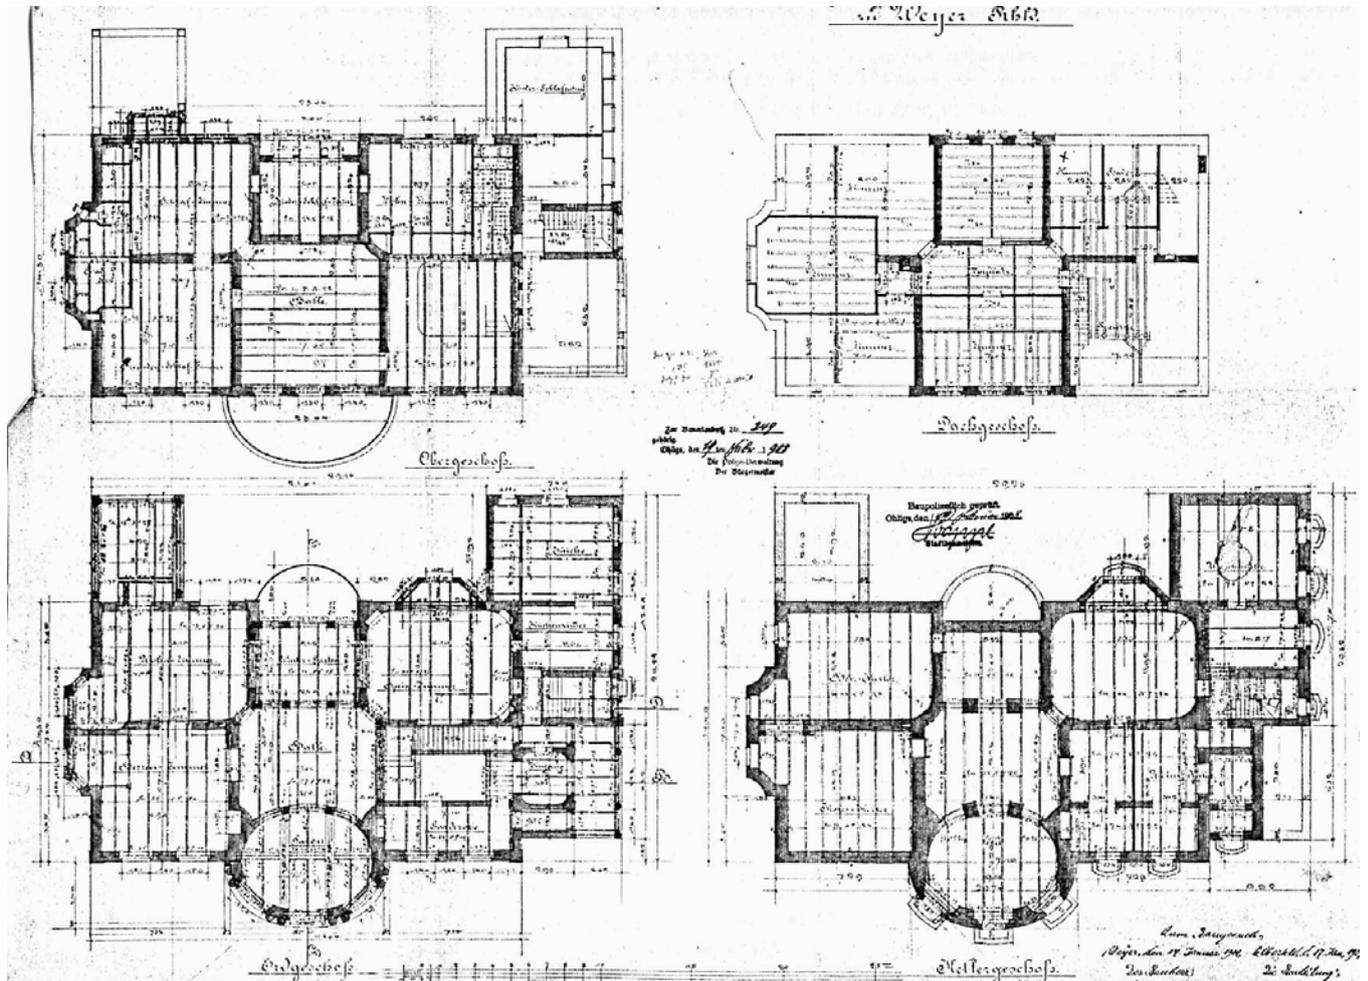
H. Plange, Grundriss Erdgeschoss (unten links), Kellergeschoss (unten rechts), Obergeschoss (oben links) und Dachgeschoss (oben rechts), Januar 1908
